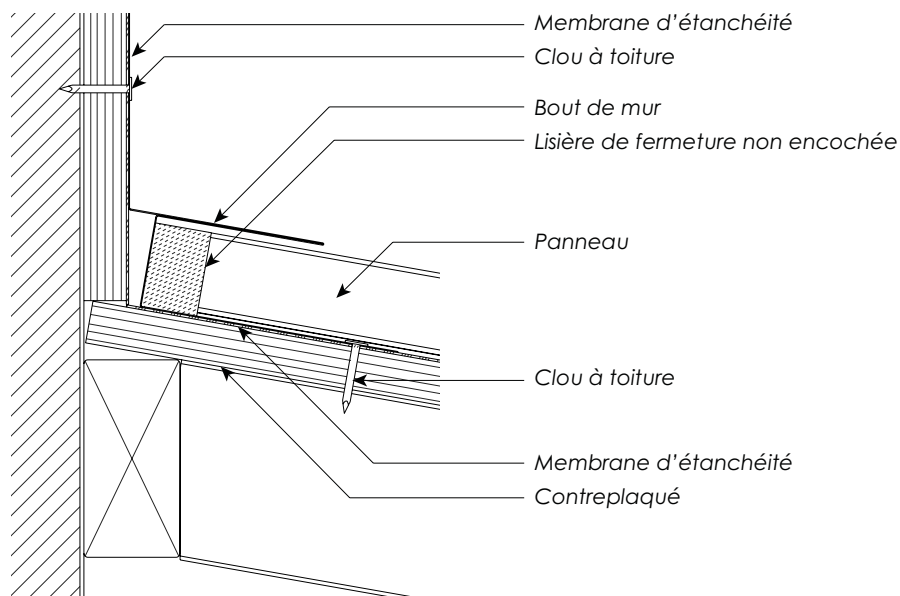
a | Vue en coupe du bout de mur – méthode 1
